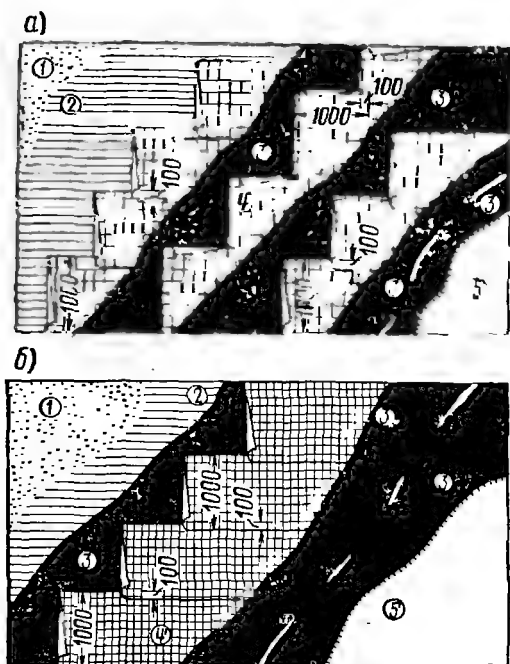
Раскладка полотнищ стекломатериалов при устройстве кровель
